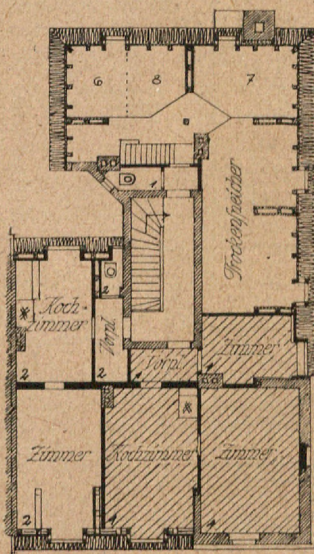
Einbau einer dreiräumigen und einer vierräumigen Wohnung in ein Dachgeschoß.
